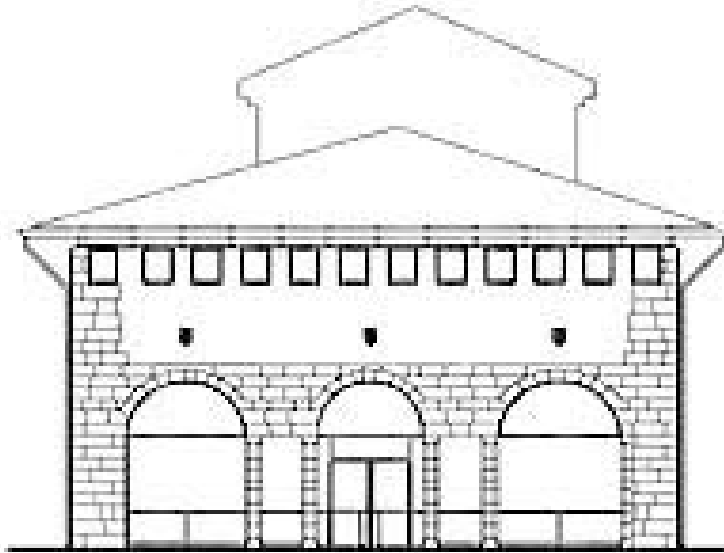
Alzado Plaza San Luis Beltrán. Fuente Web: ViA arquitectura
